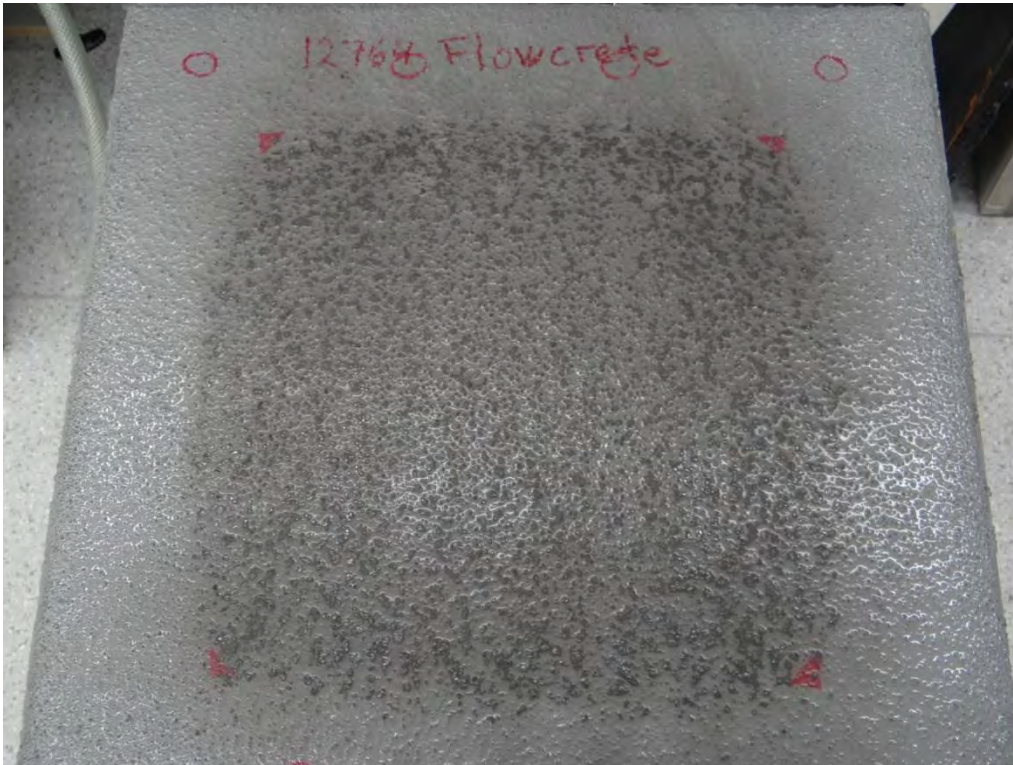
Hårdbetong – Densit efter provning enligt RWA
